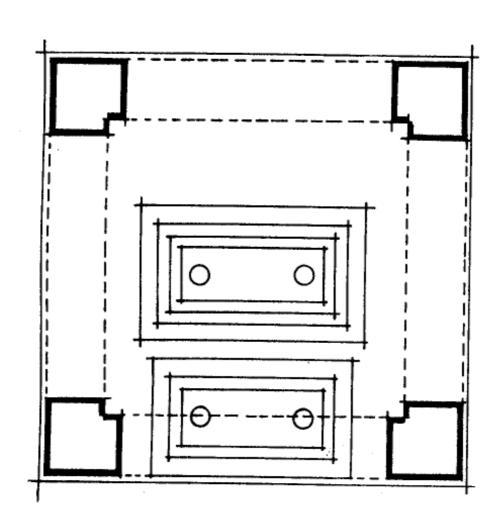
مسقط أفقى لمسجد السادا تالوفائيسة (مقياس الرسم ٢٠٠/١)
